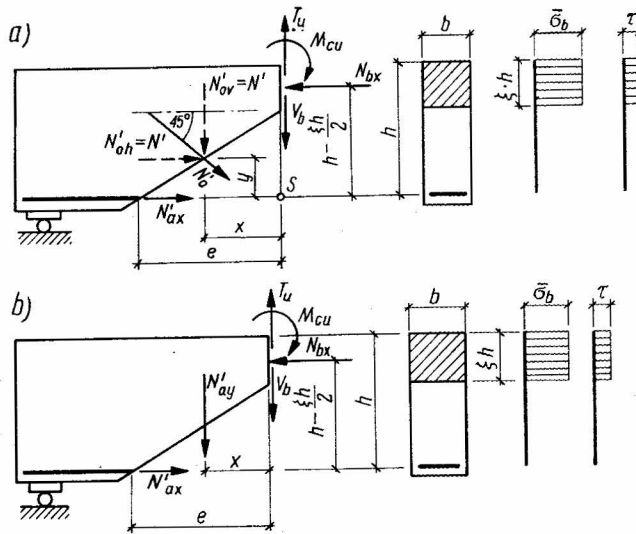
Equilibre d'une partie de la poutre, séparée par une fissure oblique d'après GYENGÖ [31]: a) poutre munie de barres relevées, b) poutre armée par des étriers
